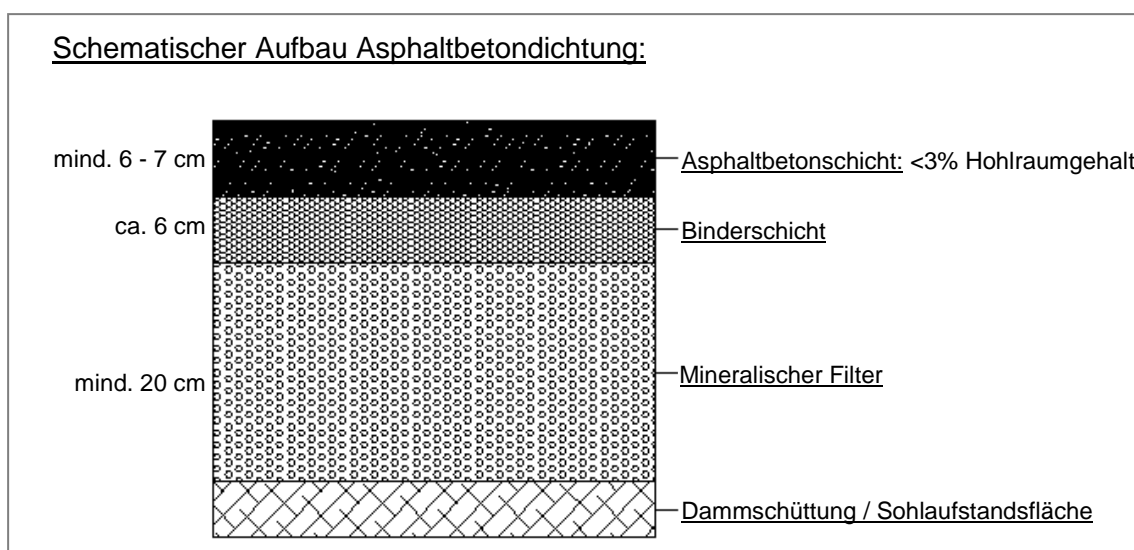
Schichtaufbau Asphaltbetondichtung
